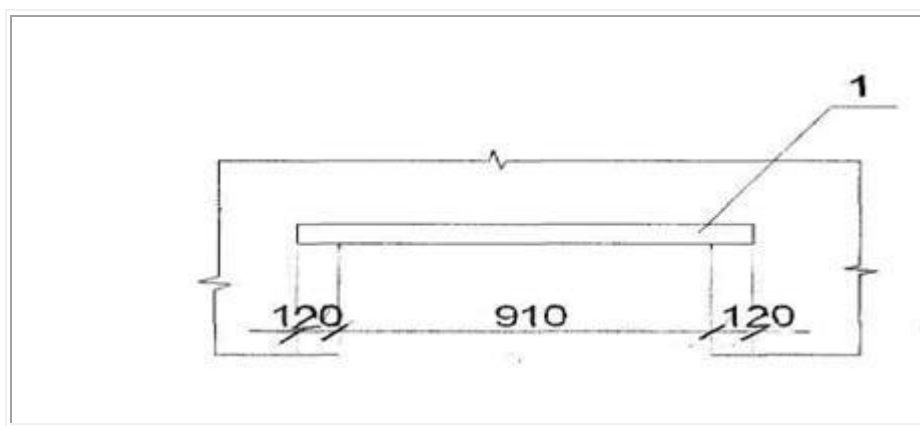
Схема опирания ненесущей перемычки над проемом.
